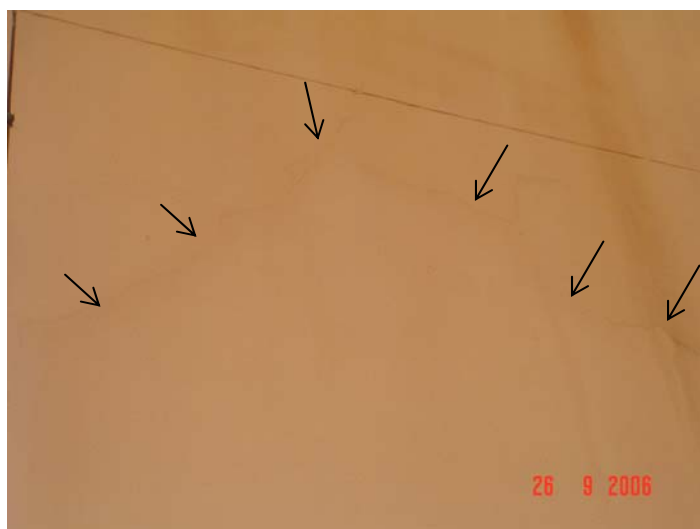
Fissuras existentes junto a parede da escadaria em torno do barrilhete, situada na fachada oeste
